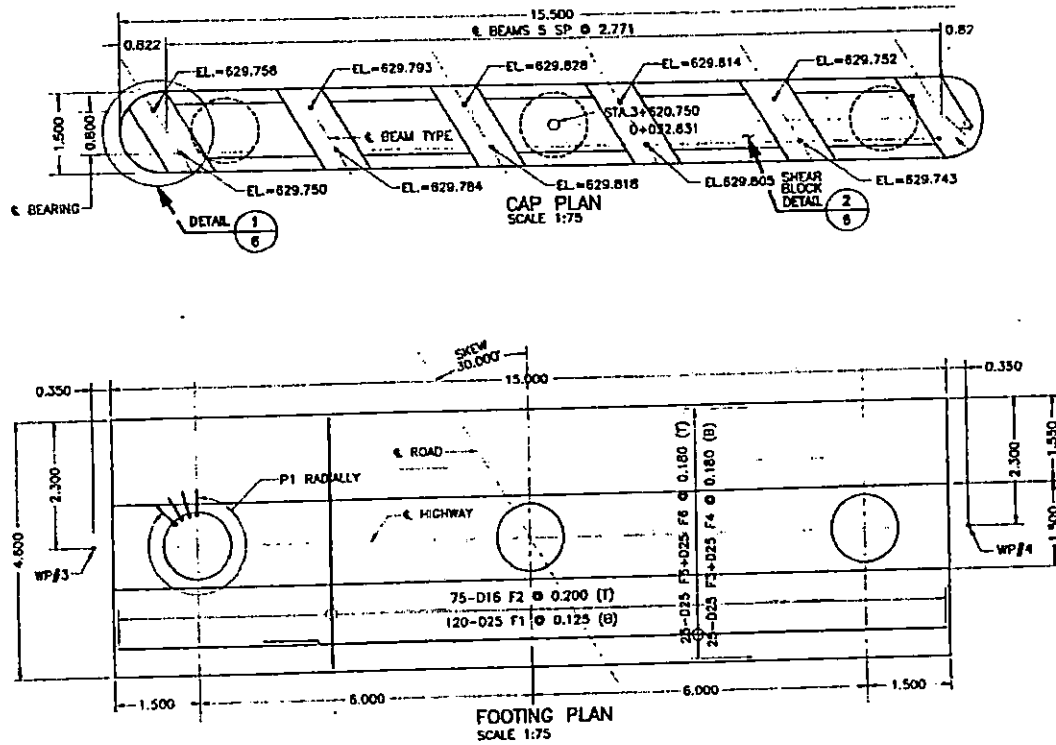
DETALLES DE PILA CENTRAL.
